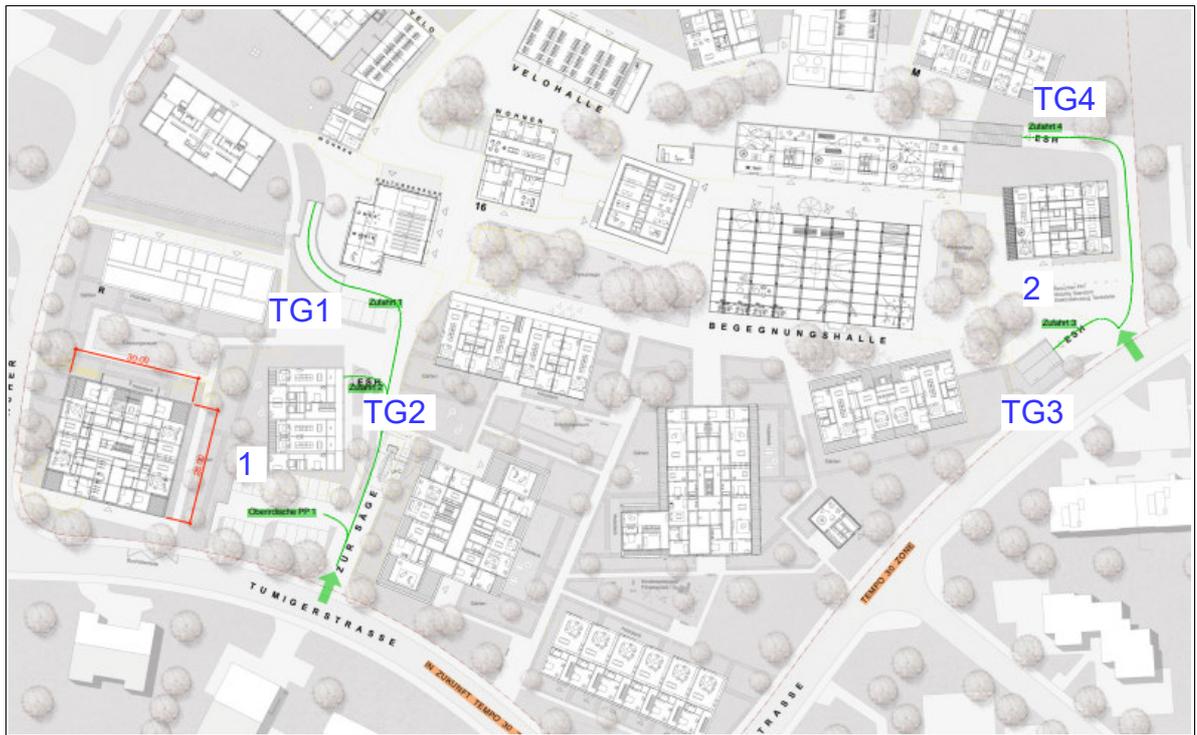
Parkierungsanlagen und Zufahrtswege
